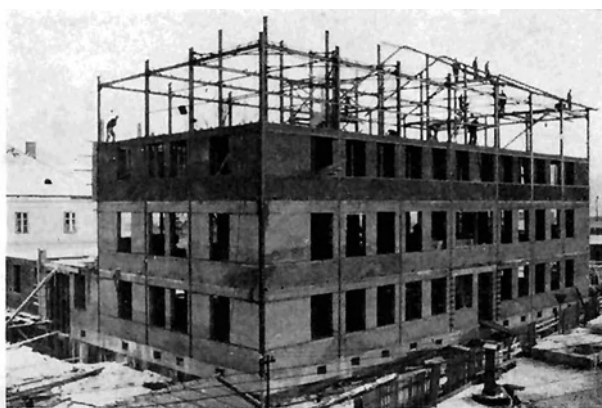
Das dritte Geschöß ist fertig ausgefacht und die Decke betoniert
